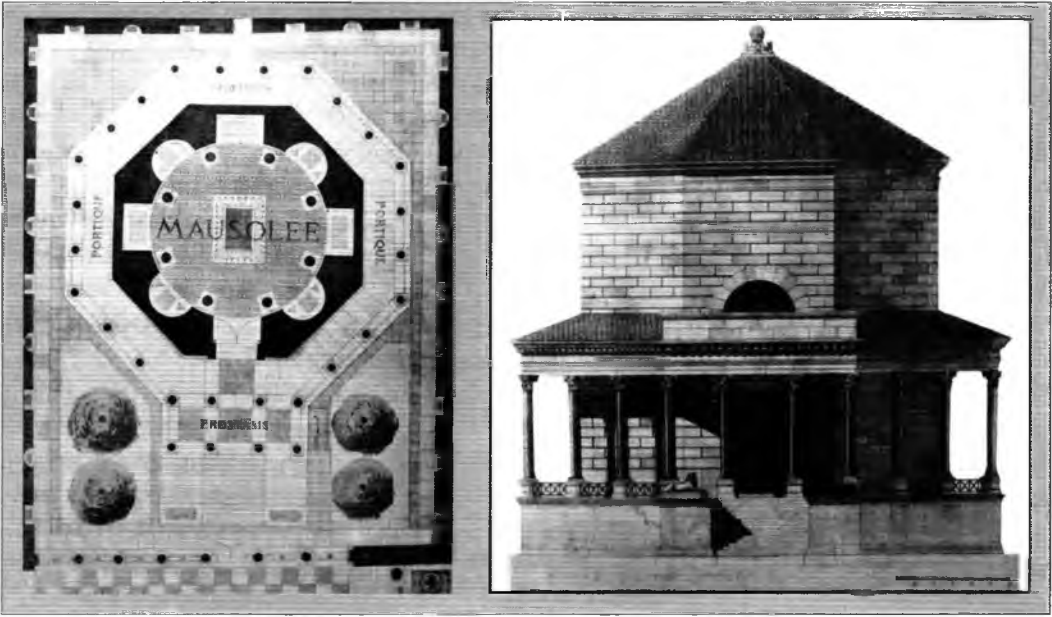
Planta y reconstrucción del Mausoleo de Diocleciano (Split) (de E. Hébrard y J. Zeiller).
